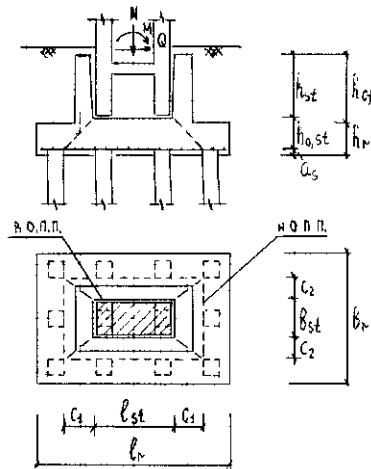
Схема образования пирамиды продавливания под сборной железобетонной двухветвевой колонной
